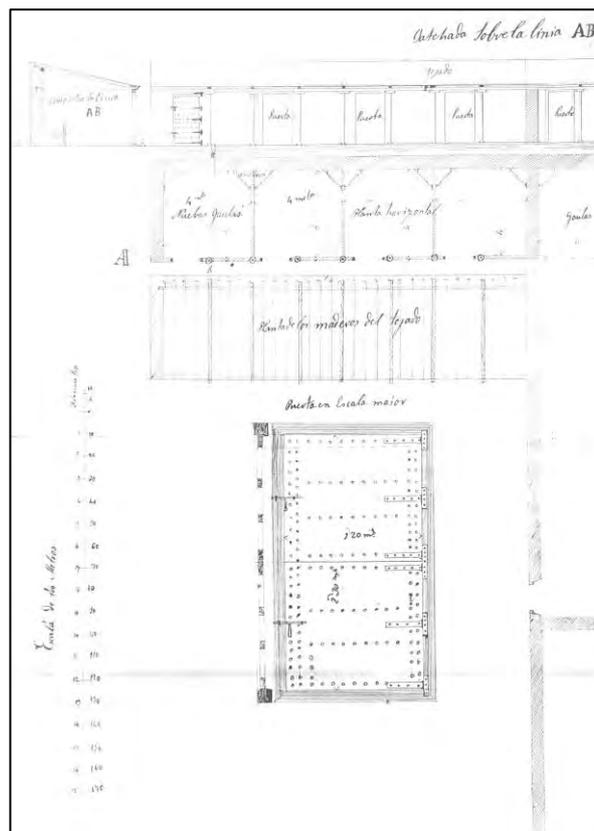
Juan Comas. *Detalle del plano de las nuevas jaulas*. 1860. AHNOB. FN 734/2 n° 1.
